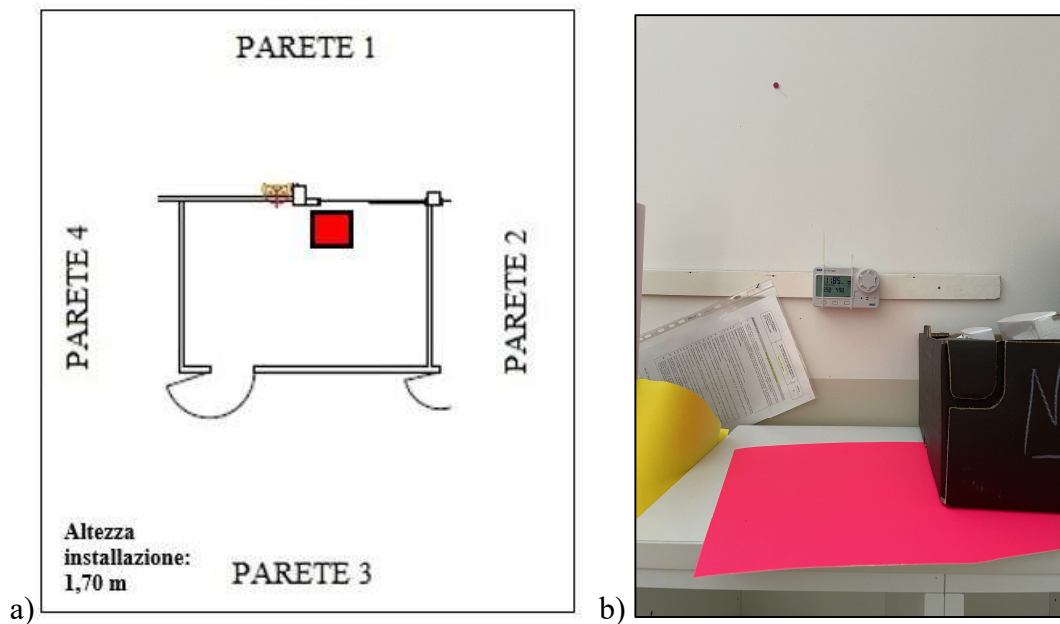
Posizione acquirente in pianta (a) e in foto (b) Aula Sostegno
